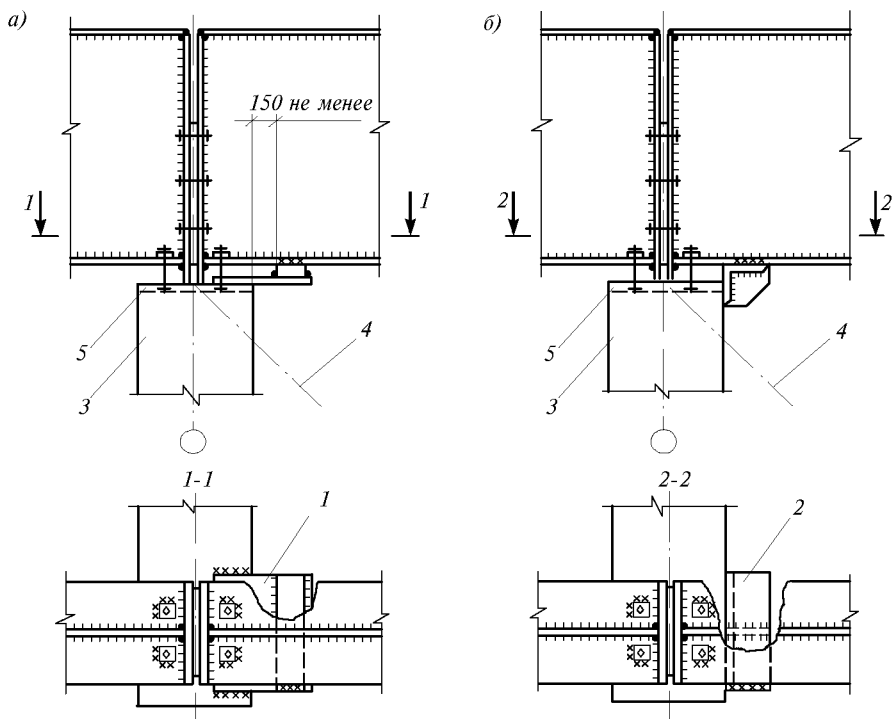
Опирание разрезных подкрановых балок на колонны в связевой панели а – на гибких планках; б – с жестким элементом; 1 – гибкие планки; 2 – жесткий элемент; 3 – колонна стальная или железобетонная; 4 – вертикальные связи по колоннам; 5 – закладной элемент в железобетонной колонне
